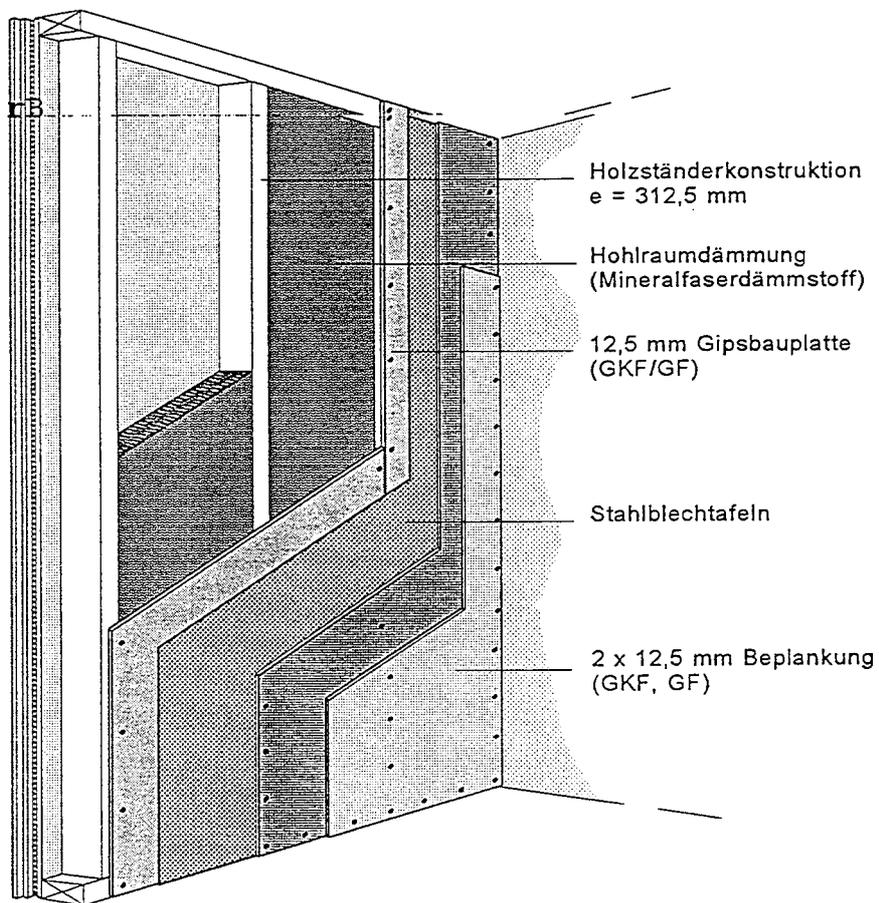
Beispielhafter Aufbau einer "Brandwand" in Trockenbauweise mit Holzunterkonstruktion
